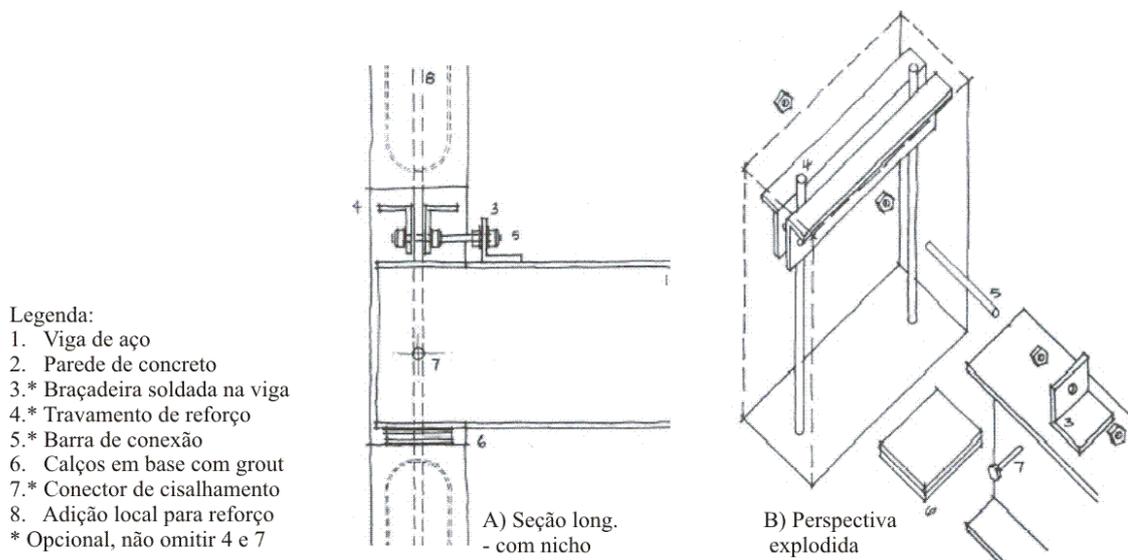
Interface entre viga de aço e parede de concreto com nicho.
